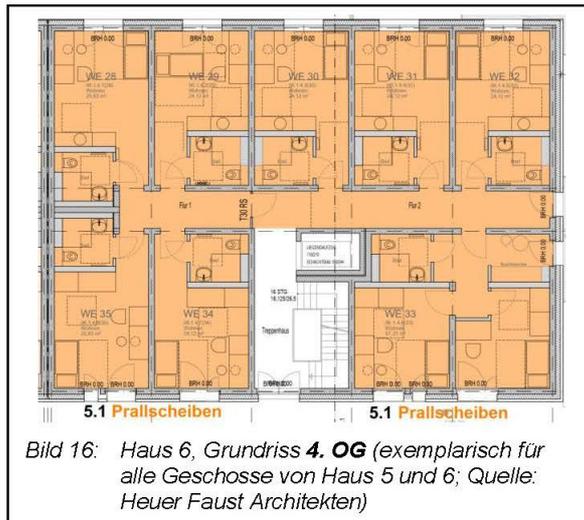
Haus 6, Grundriss 4. OG (exemplarisch für alle Geschosse von Haus 5 und 6; Quelle: Heuer Faust Architekten)
